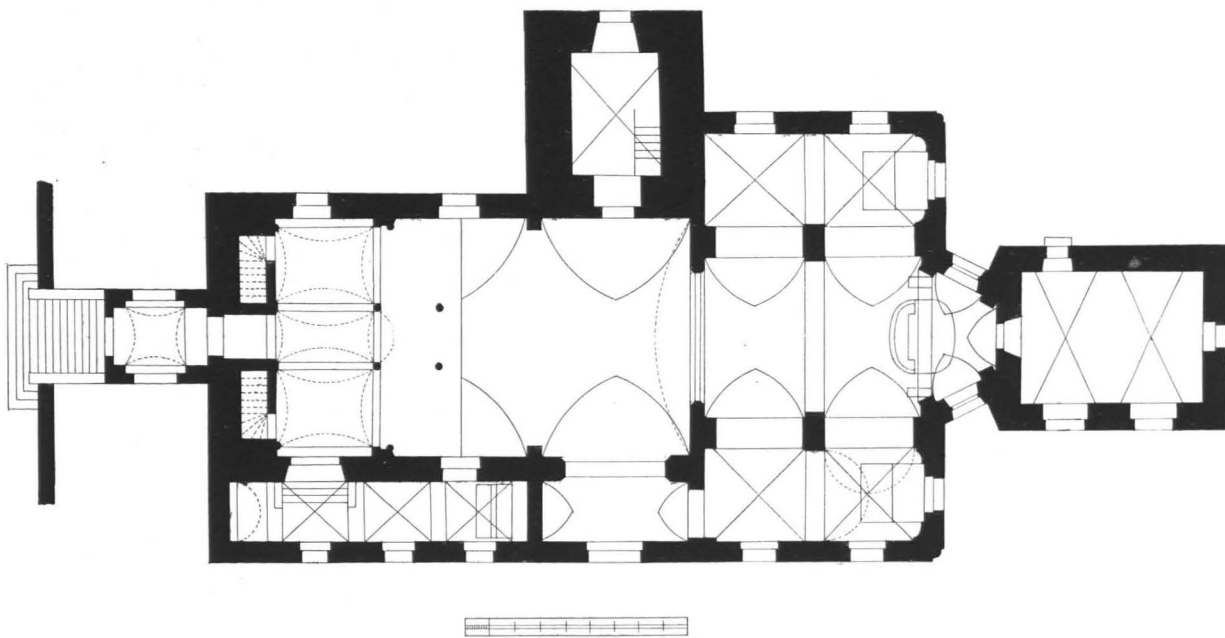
Köstendorf, Pfarrkirche, Grundriß 1 : 300 (S. 84)
